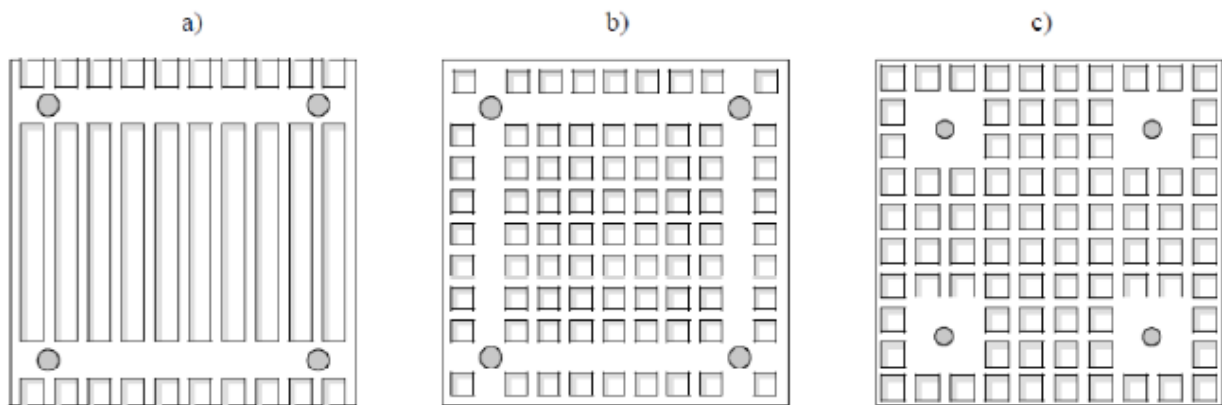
Exemplos de lajes fungiformes aligeiradas nervuradas [B11]
